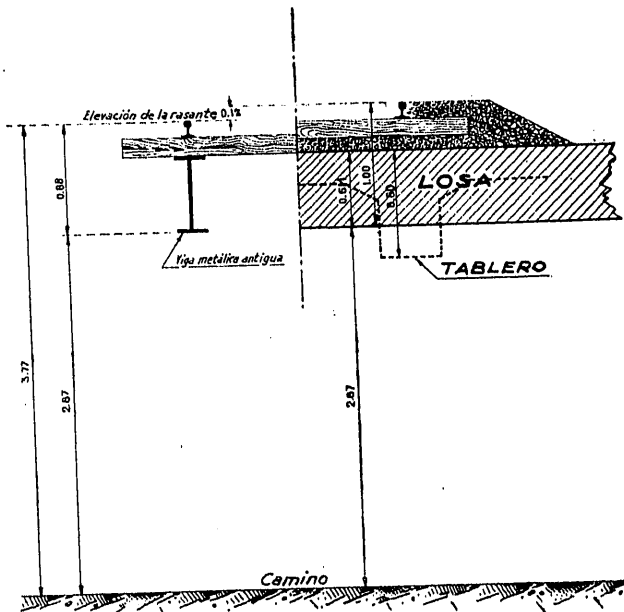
Pontón Cua, en la línea de Galicia. Comparación de los cantos de las soluciones metálica, con losa y con tablero de hormigón armado.
